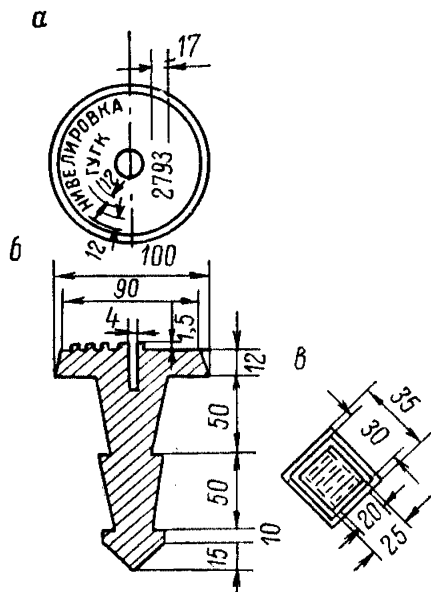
Нивелирная марка. а — вид сверху с диском; б — разрез; в — вид сверху без диска.
